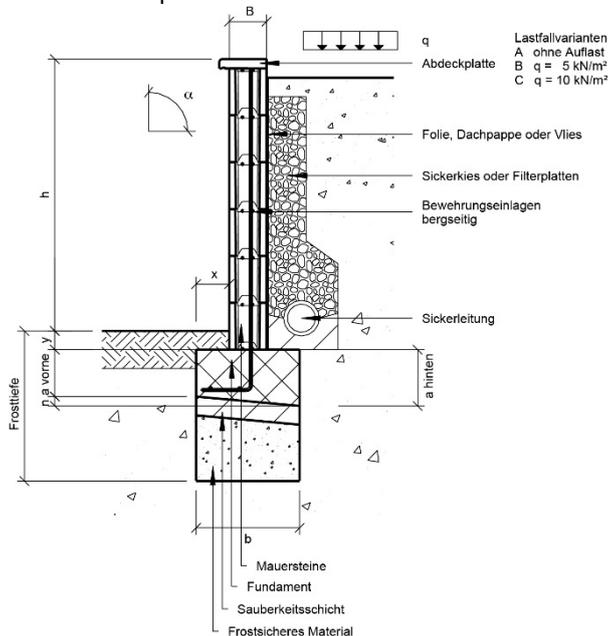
Aufbauquerschnitt mit Bewehrungsmöglichkeit
